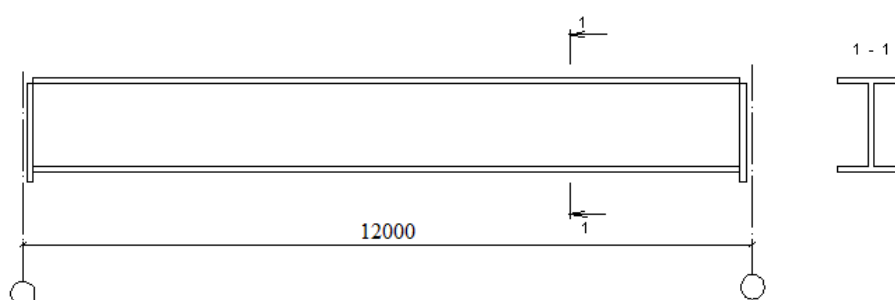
Балки подкрановые, серия I.426.2-7, марка Б12-230Ш2
